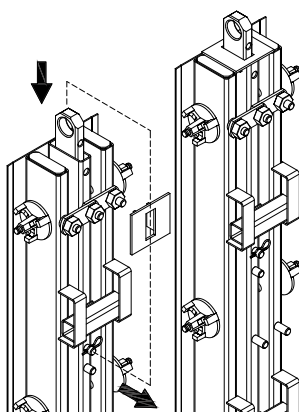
Przykład zmontowanego szalunku szybu windowego
